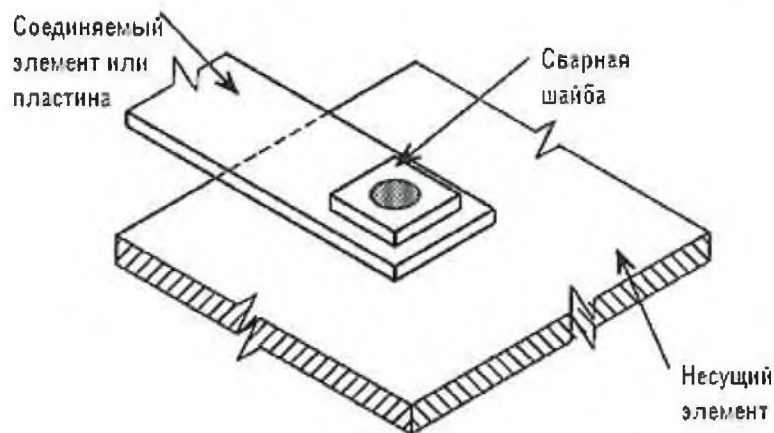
Дуговая точечная сварка со сварной шайбой
